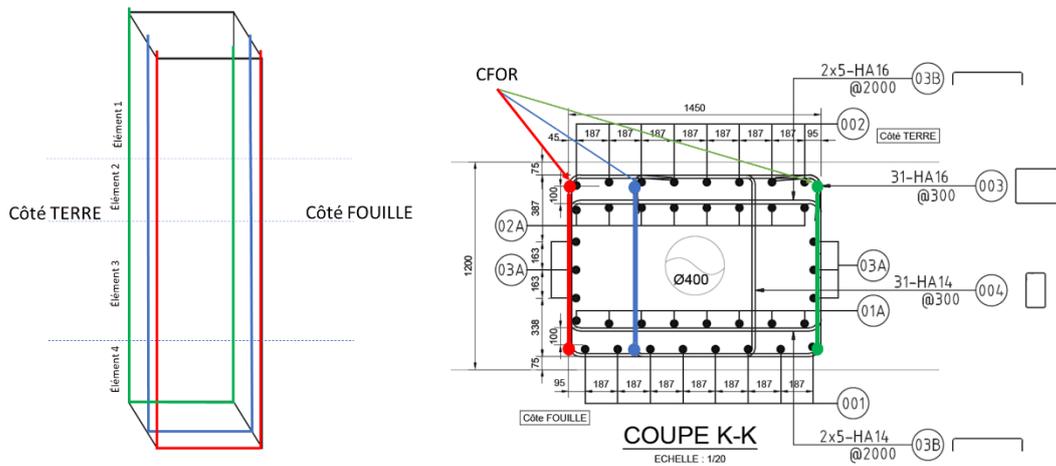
Plan d'installation de fibre optique sur la cage C7c
